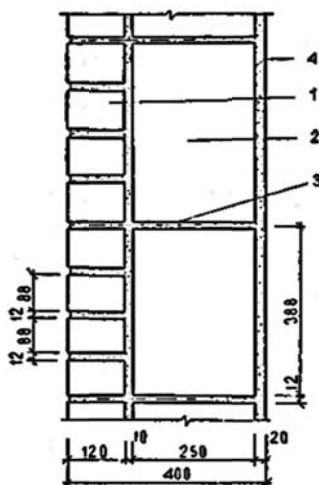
Конструкция кладки из газосиликатных блоков с облицовкой:
